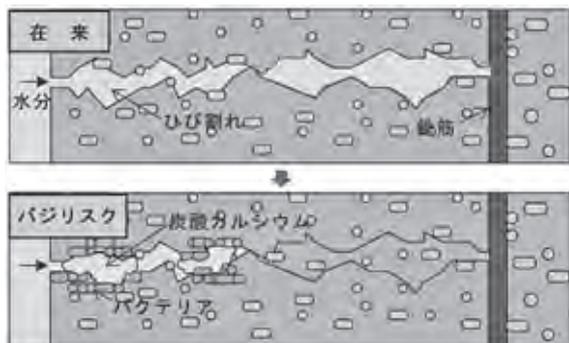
バクテリアによるひび割れ自己治癒概念図
